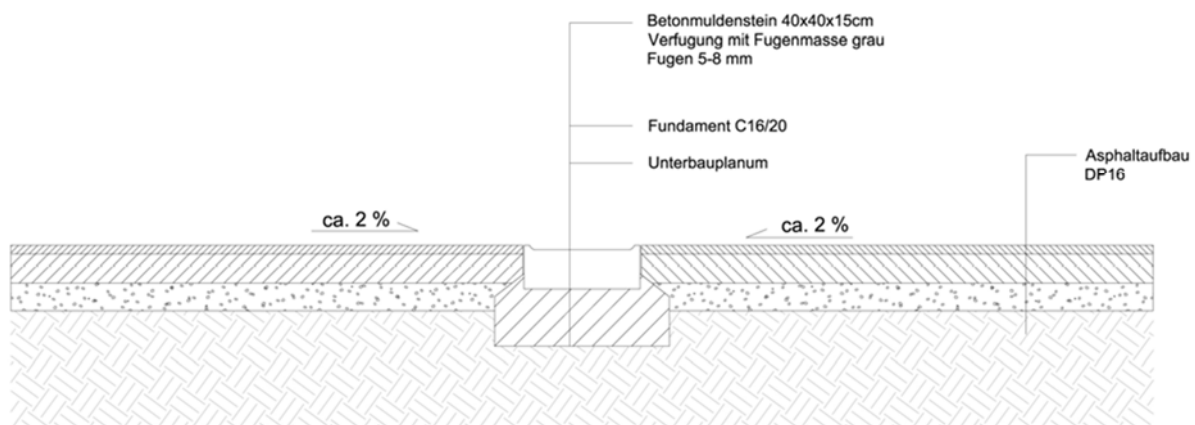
Betonsteinmulde, Detail: Büro Jakob Fina
